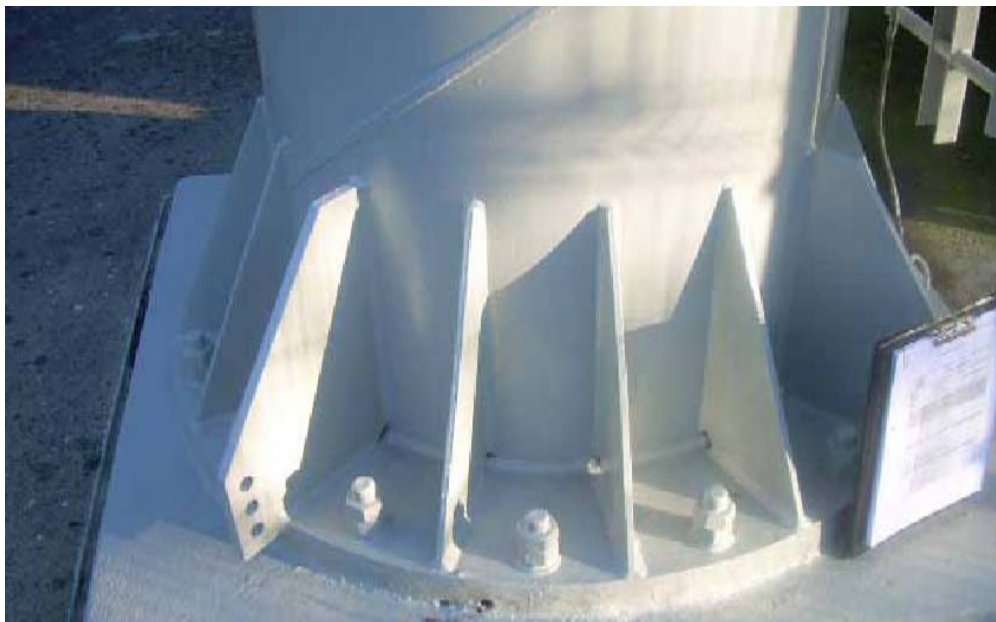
Pormenor dos novos cordões de soldadura nos cutelos de reforço da fundação
